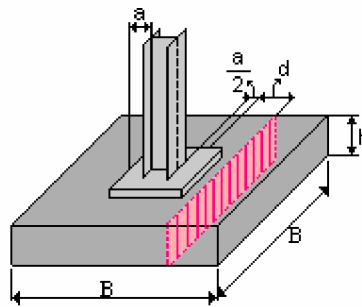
Cortante unidireccional en zapata que soporta columna metálica.
